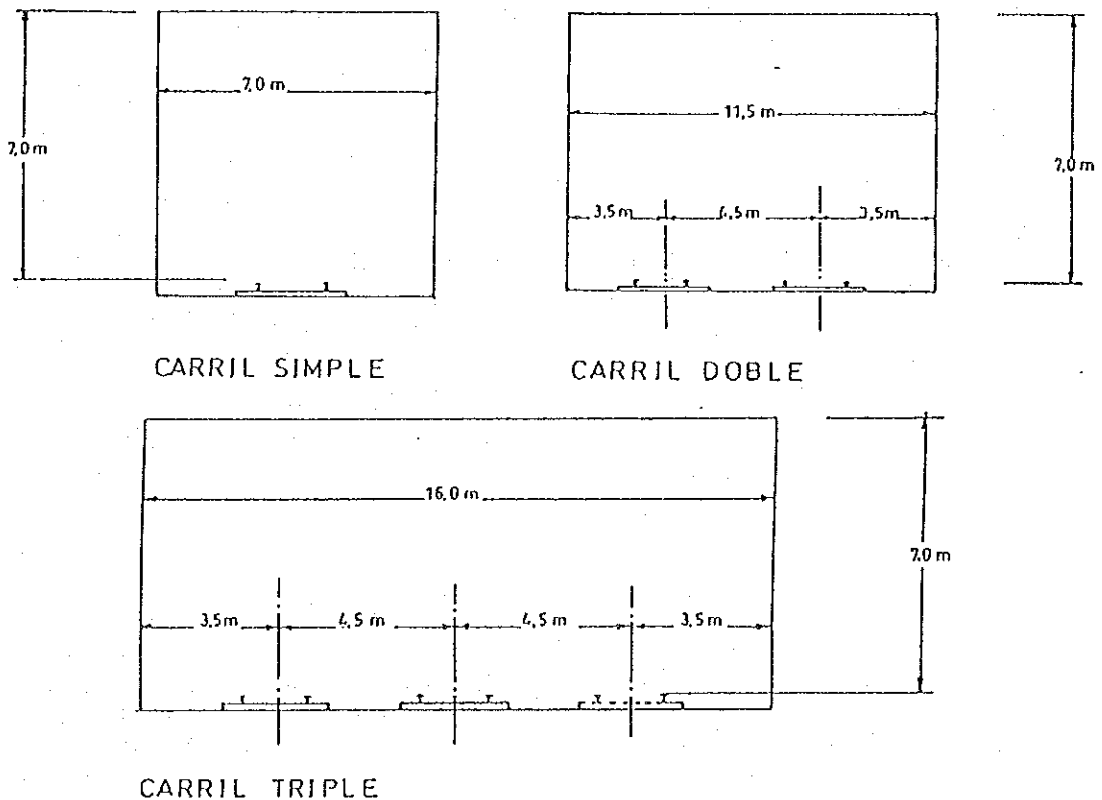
Espacio libre para la construcción sobre ferrocarriles
